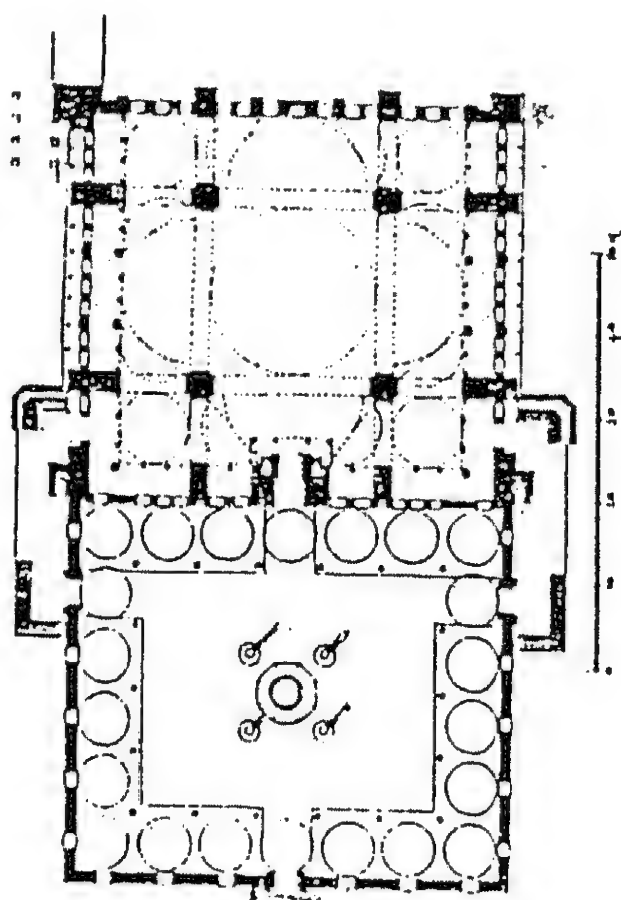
مسقط أفقي لمجمع شاهزاده في إستانبول (عن : اصلان ابا) .
